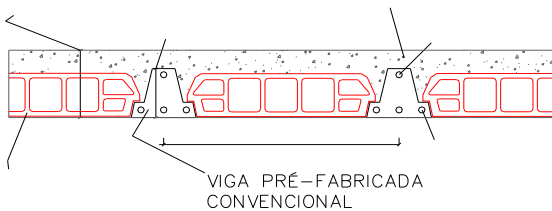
LAJE PRÉ-FABRICADA CONVENCIONAL
